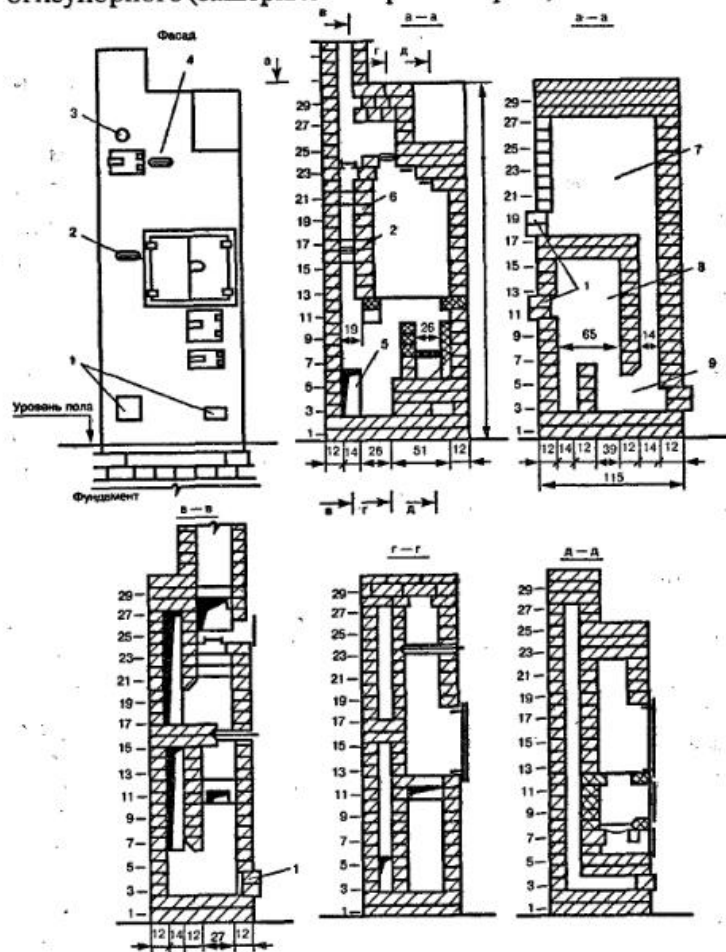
Разрезы отопительно-варочной печи ИП-1. Размеры в см: 1 — чистки; 2 — задвижка летнего хода (13×13 см); 3 — душник; 4 — вентиляционная задвижка (13×24 см); 5 и 6 — отверстия для входа газа в нижний колпак и дымовую трубу; 7 — верхний колпак; 8 — нижний колпак; 9 — подвертка перехода
